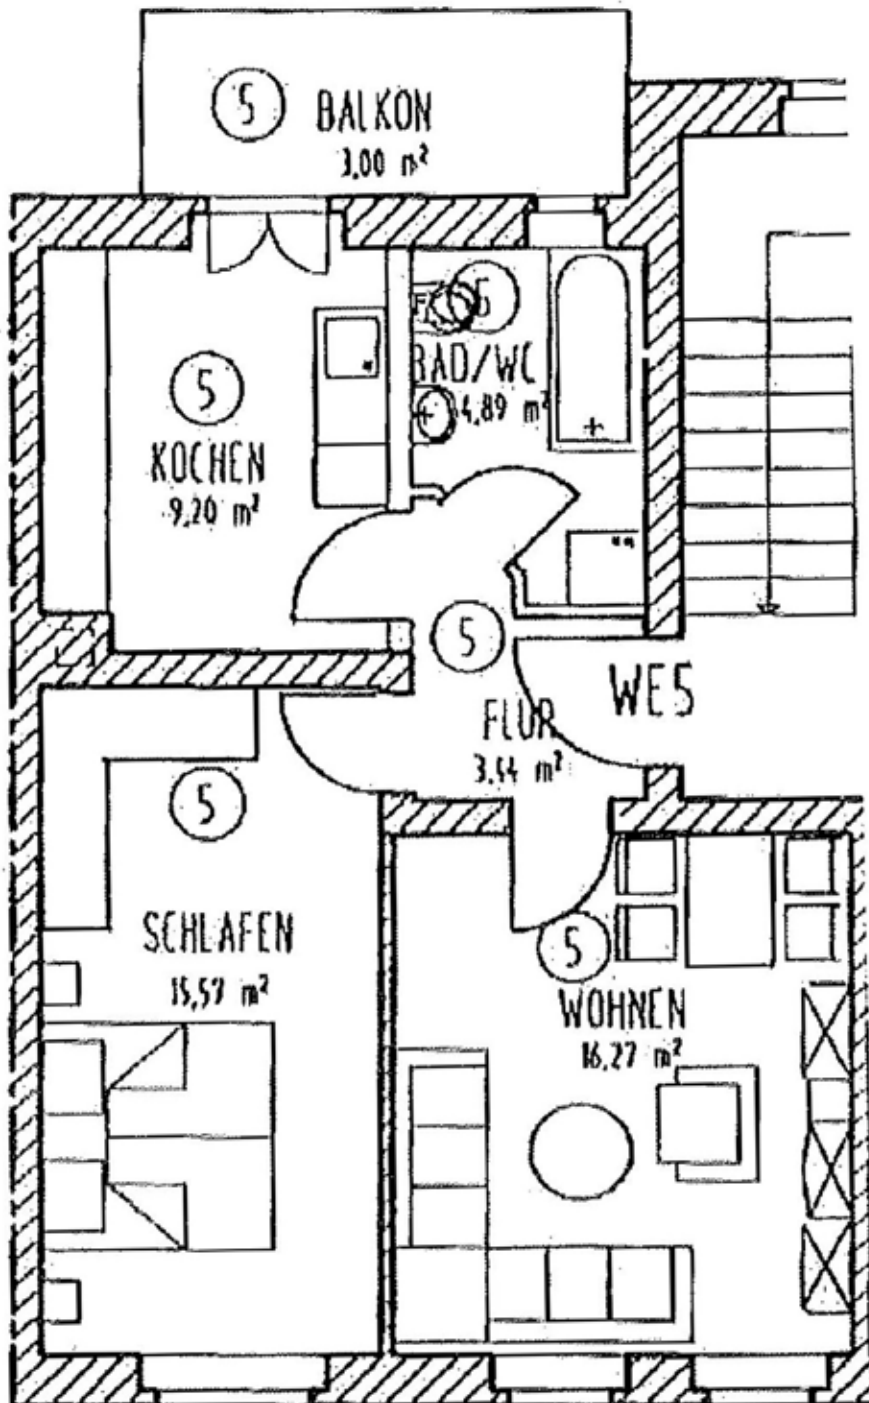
Grundriss der Wohneinheit Nr. 5
